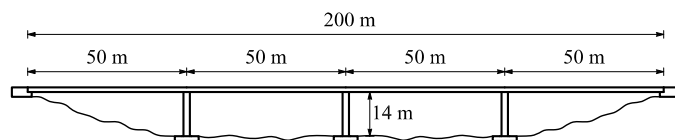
Continuous reinforced concrete bridge / Ponte a travata continua in calcestruzzo armato.
